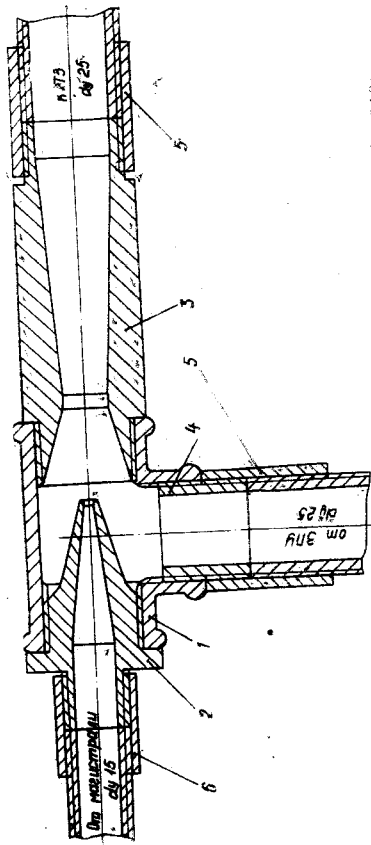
Инжектор-ускоритель (черт. 70015-00.000, п/я А-7210):
